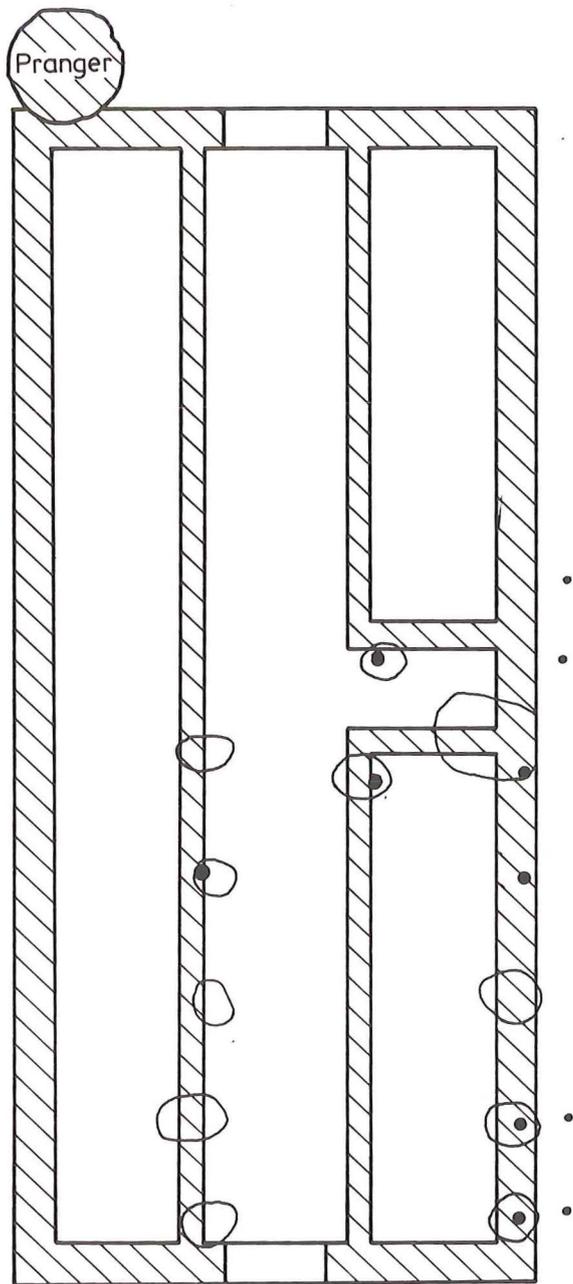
St. Pölten, Markthalle und hölzerner Vorgängerbau auf dem Breiten Markt (Rathausplatz): rekonstruierter Grundriß.
